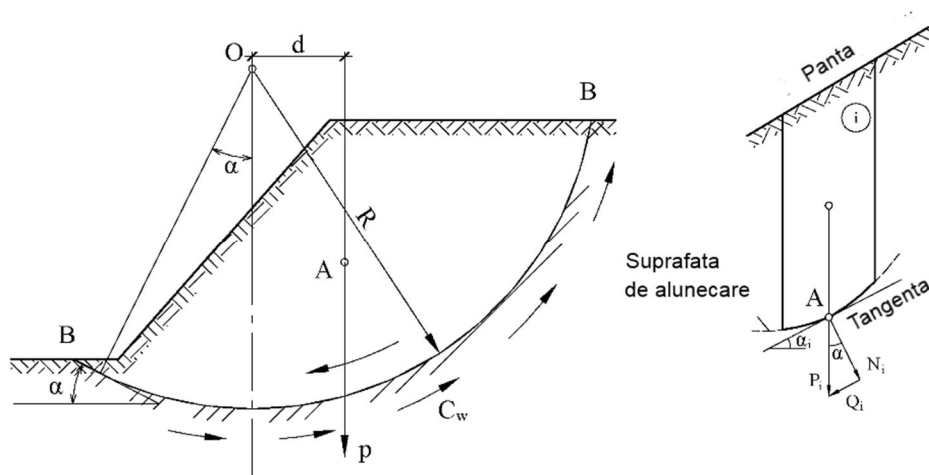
Schema de calcul pentru evaluarea stabilității versantului după metoda suprafeței cilindrice de alunecare
